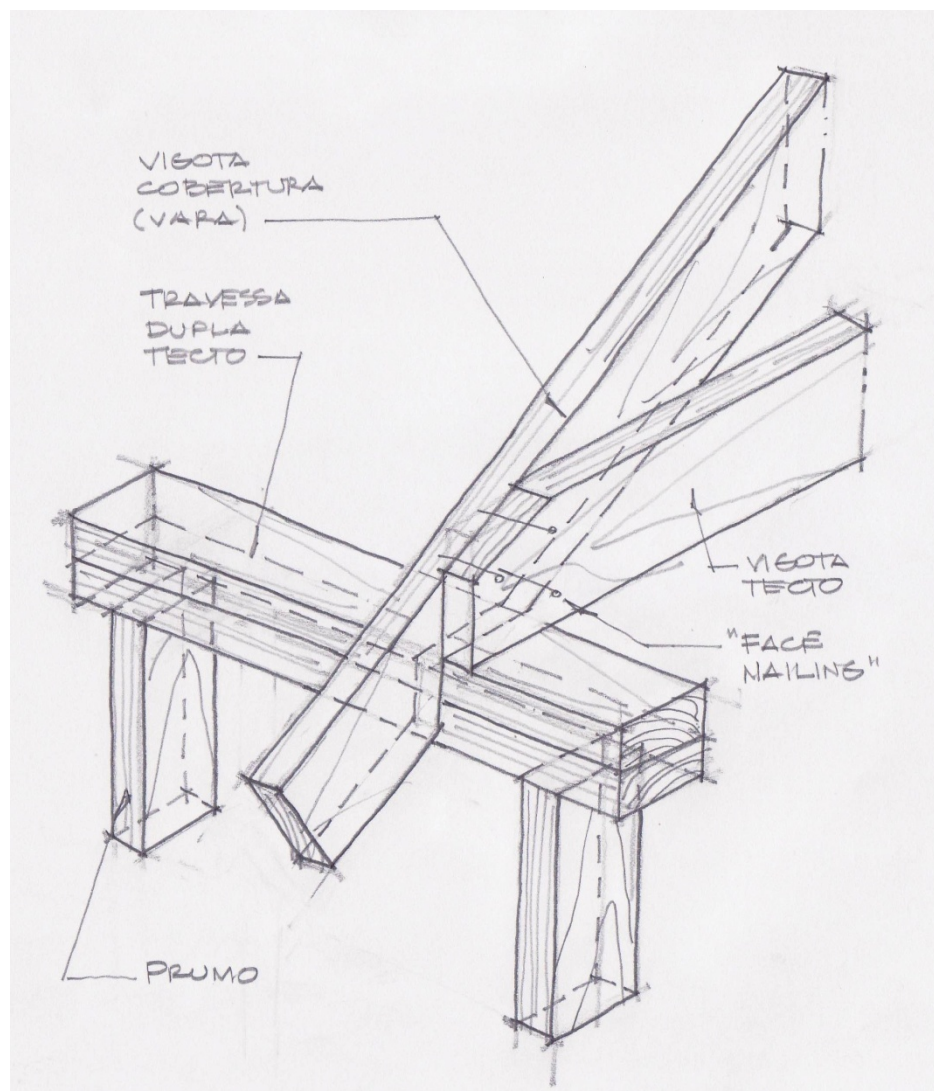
Pregagem entre vigotas de cobertura e tecto sobre apoio em parede exterior. (des. autor)
